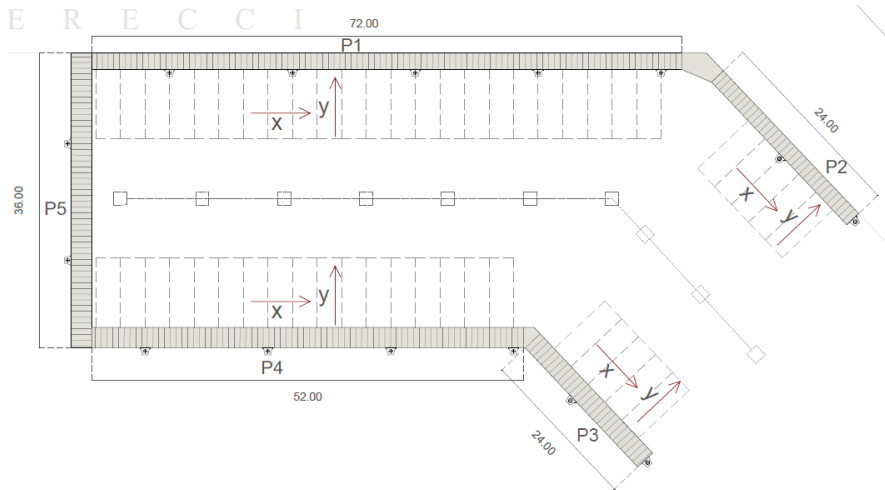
Stralcio planimetrico pontili galleggianti per la piccola pesca - barche da 8 m
